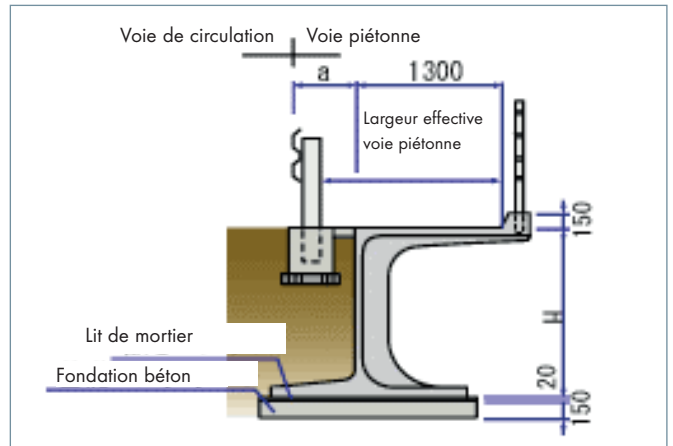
Schéma d'un mur de soutènement 'Road L'
